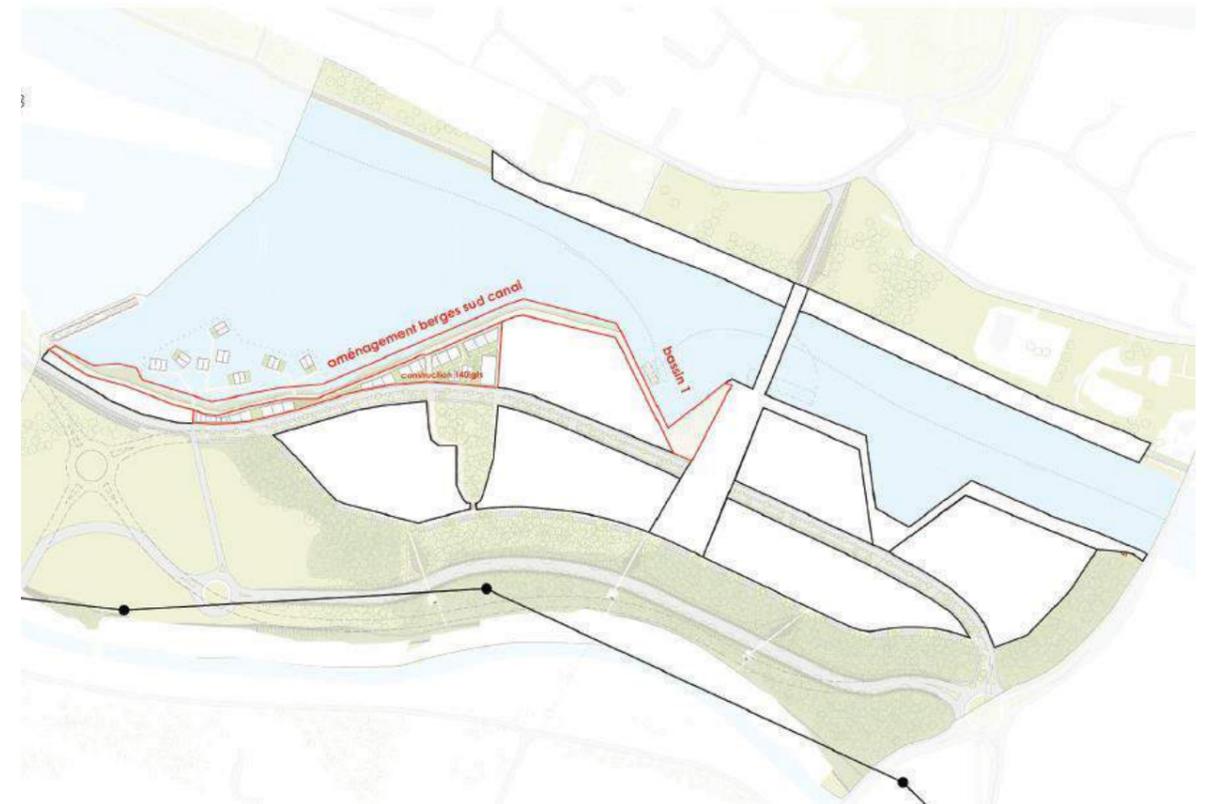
Phase 1 – Site Paysages habités à Hérouville (source : Plan Guide MVRDV)
